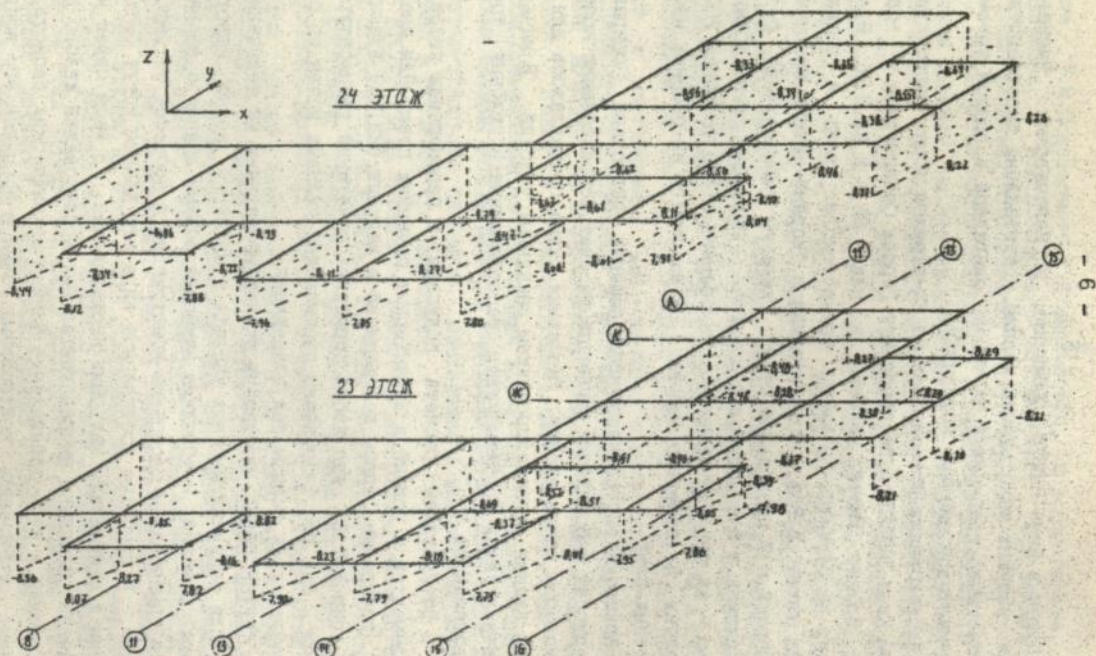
Значение перемещений по оси Z узловых точек 23-ого и 24-ого этажей на уровне перекрытий при воздействии усадки бетона на этапе возведения ( в мм )
